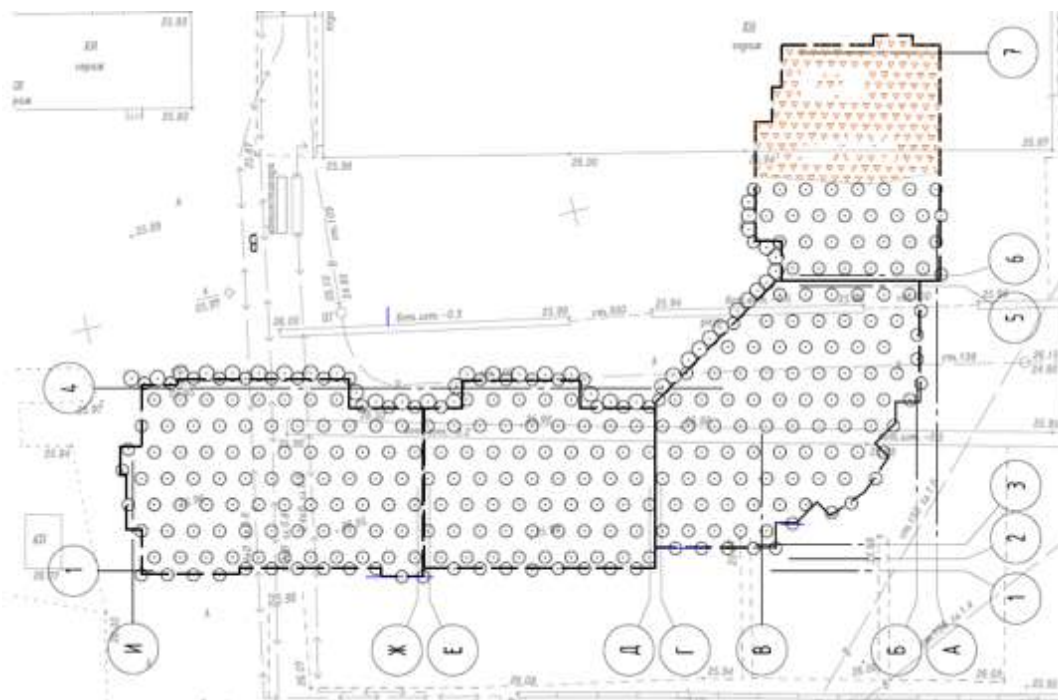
Схема расположения вертикальных грунтобетонных армирующих элементов
